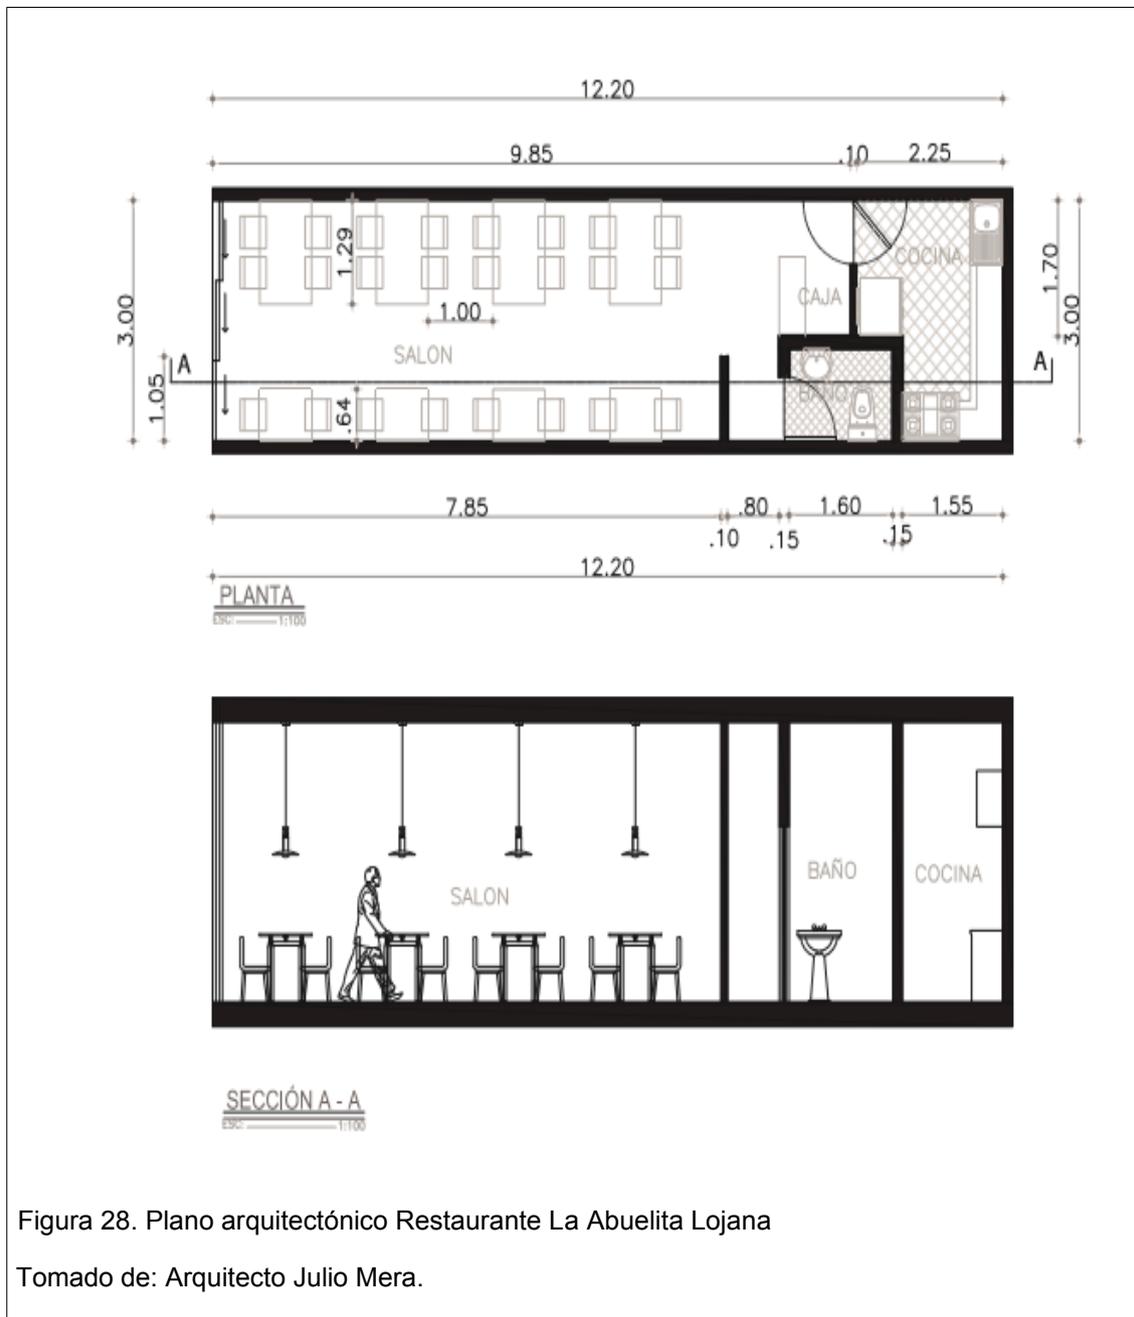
Plano arquitectónico Restaurante La Abuelita Lojana
